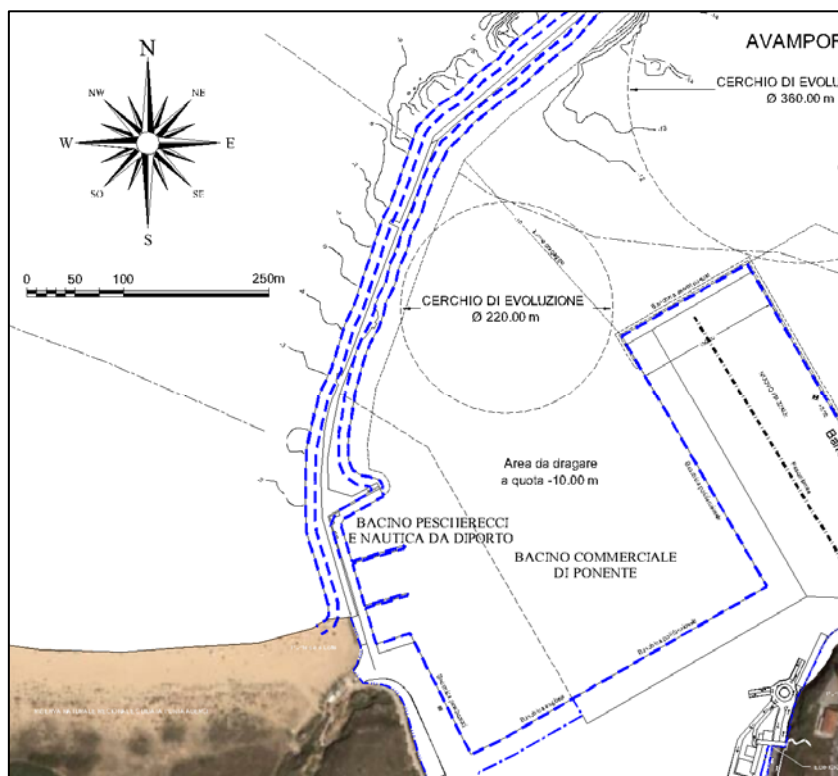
Bacino commerciale di ponente: planimetria di progetto con l'indicazione del canale di accesso
